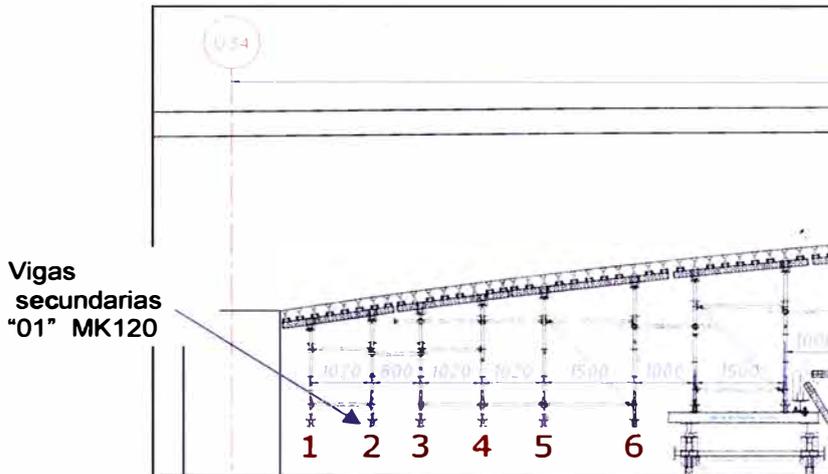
Elevación – vigas secundarias "01" sección 1-6 (mm).
